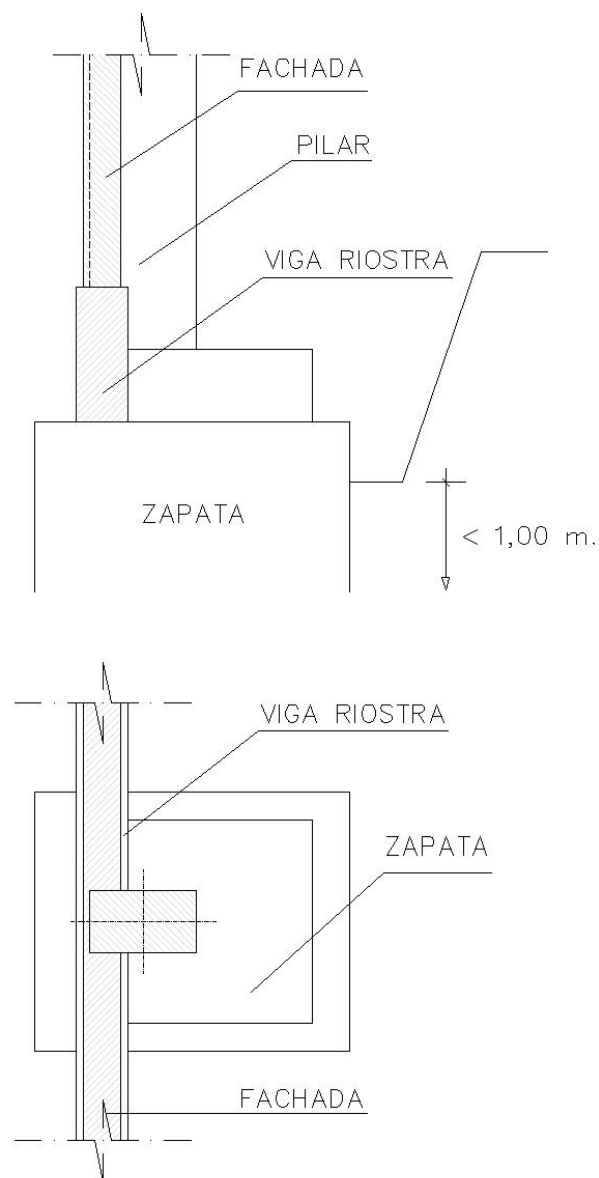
Detalle de las cimentaciones de los pilares 10A y 19A.
